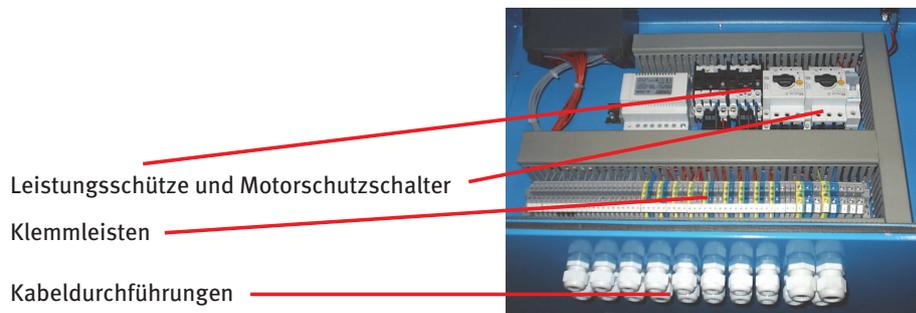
Elektrotechnik einer Wärmepumpe
